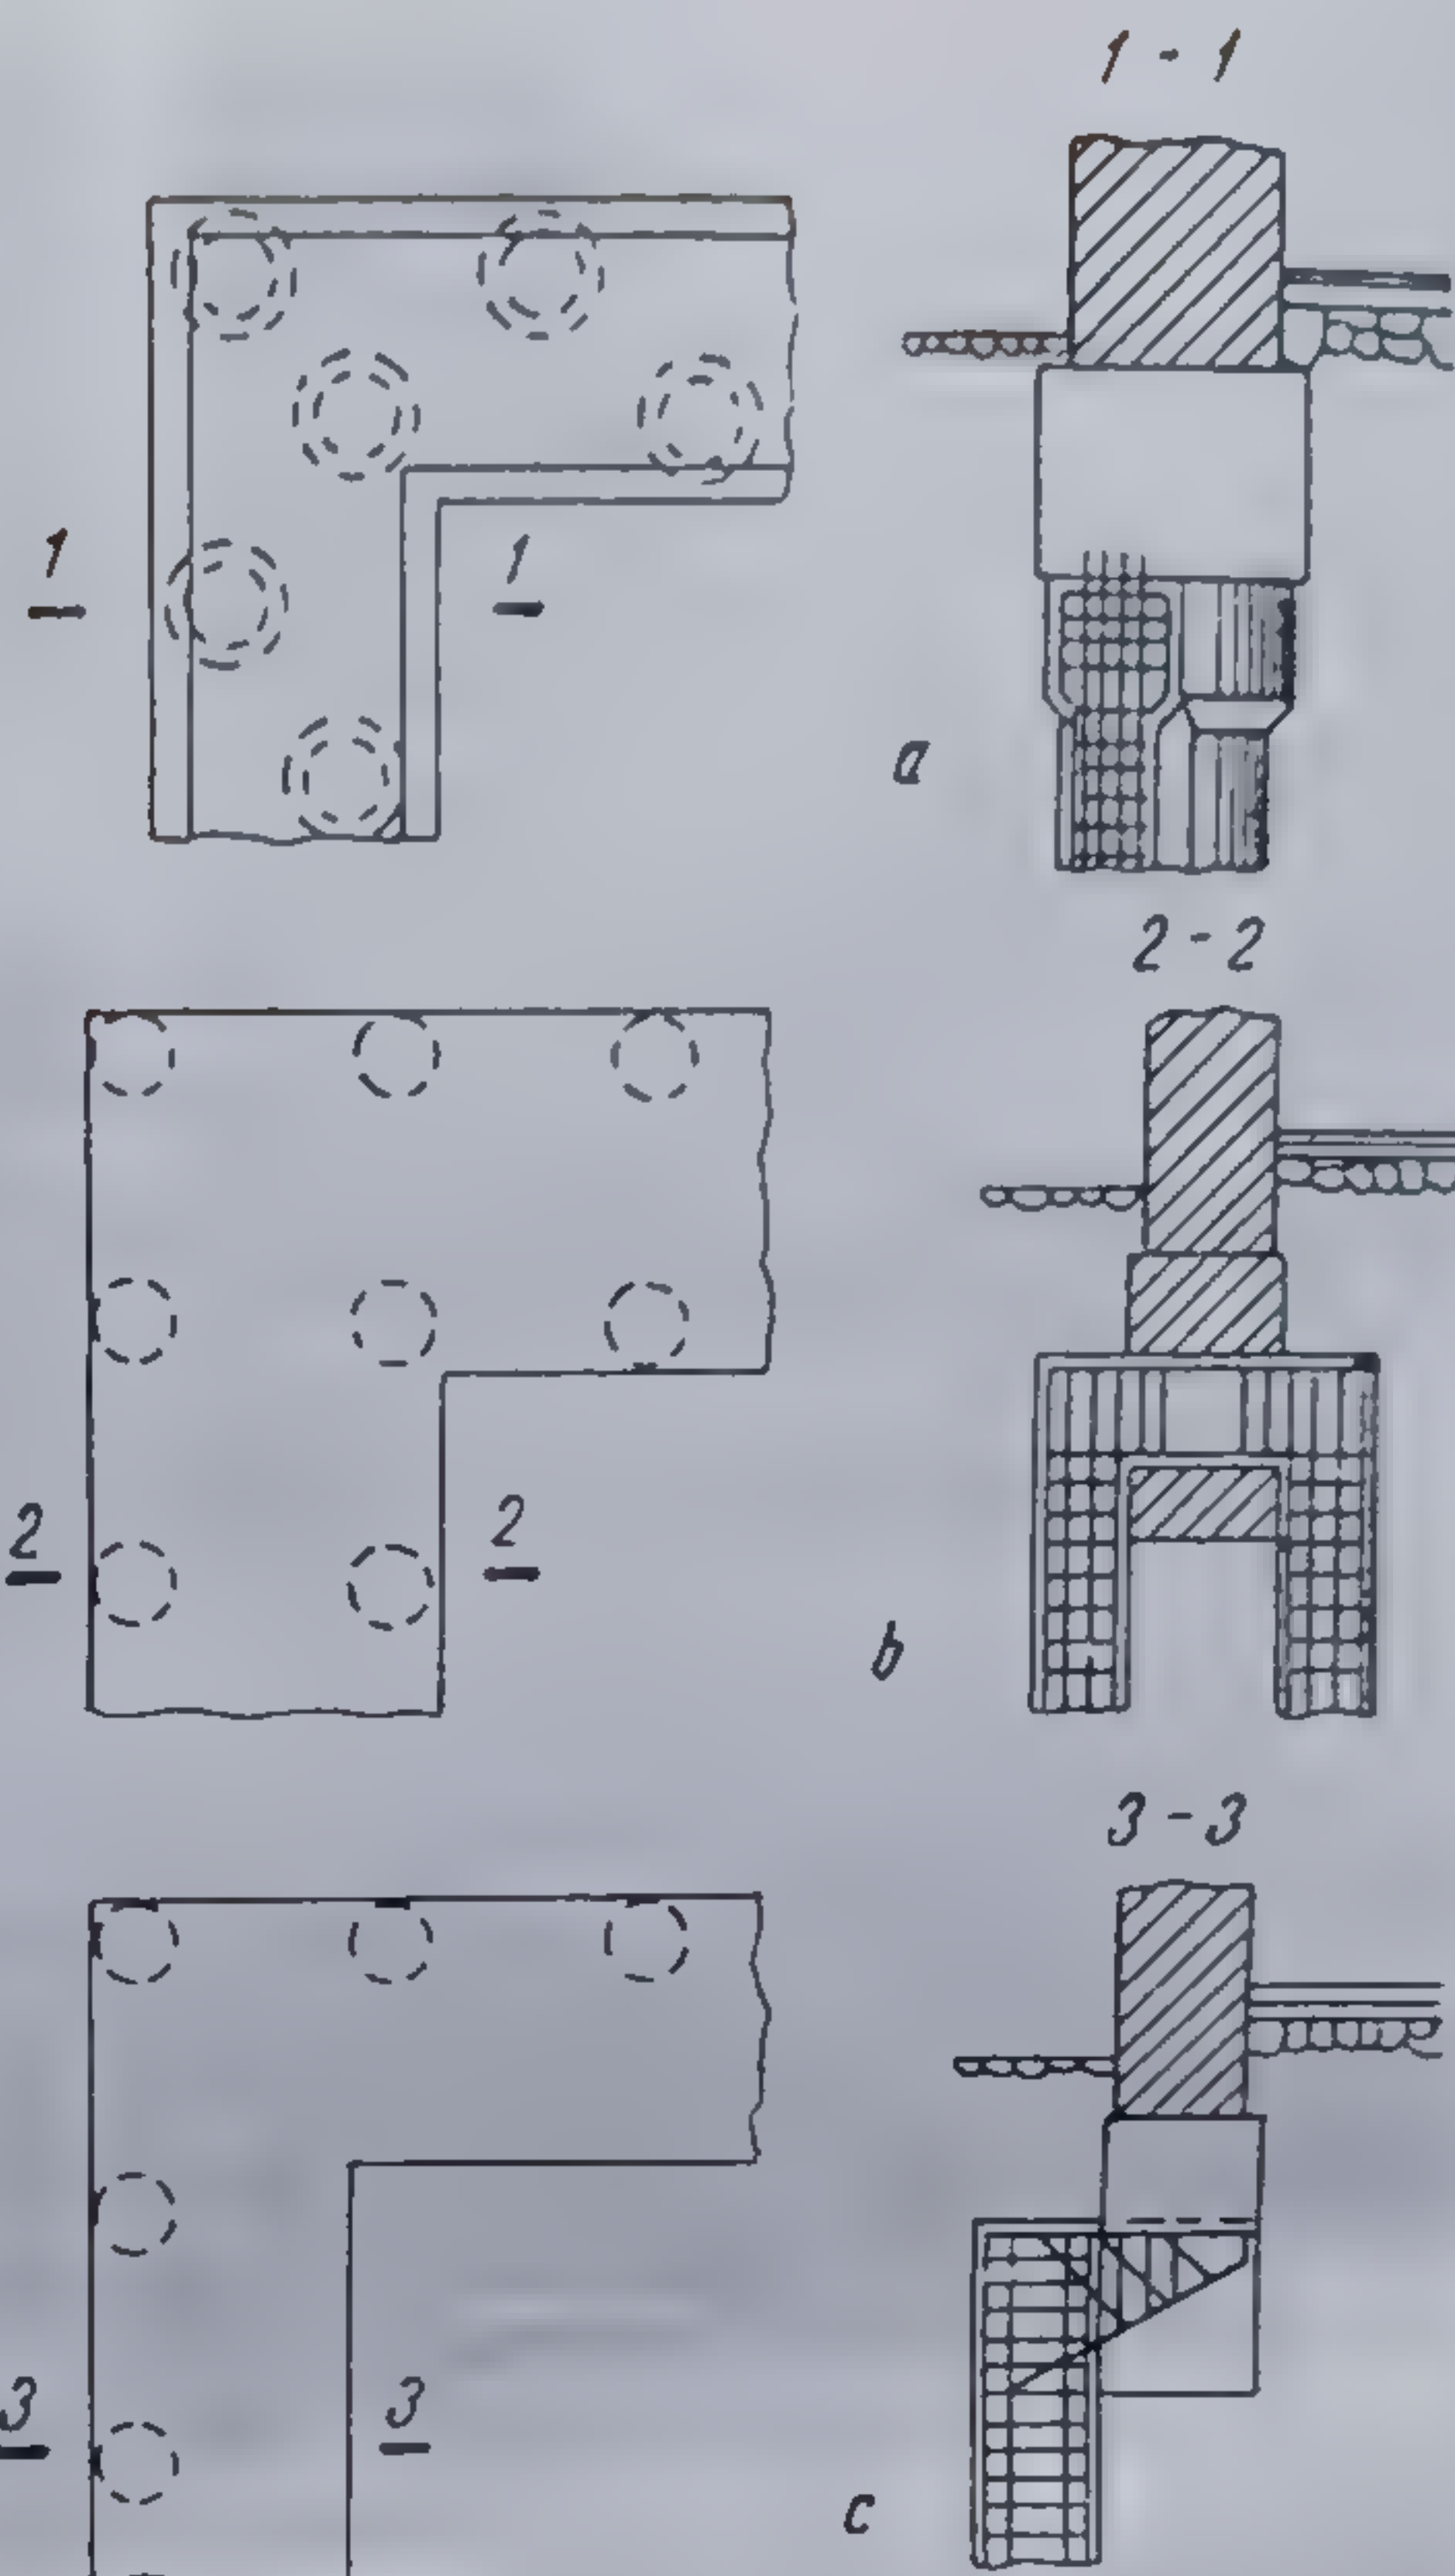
Consolidări-cu piloți din beton armat forăți:
